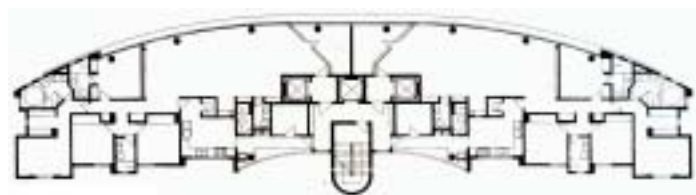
Edifício Corbusier (1991-96): planta andar tipo.
